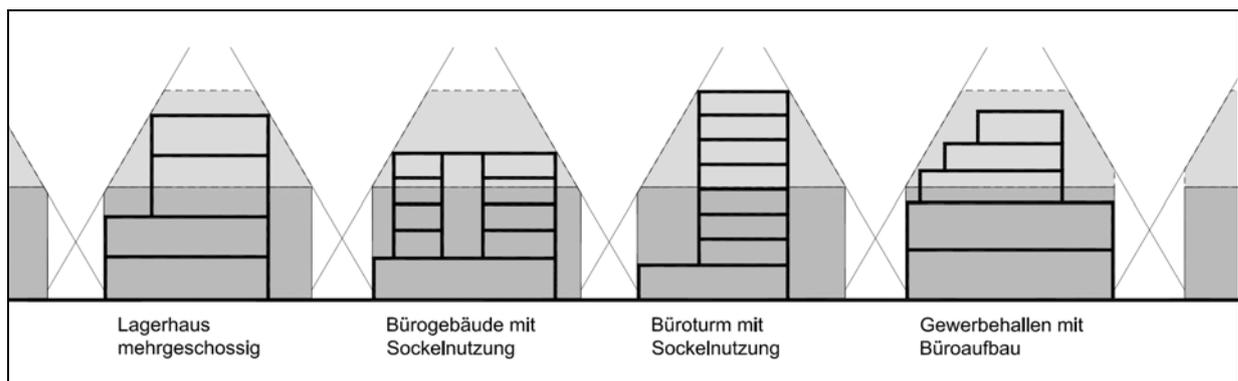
Schnitt durch Regelbauareale mit möglichen unterschiedlichen Nutzungs- und Bauungsformen (Darstellung S&A)
